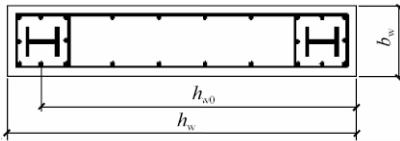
型钢混凝土剪力墙斜截面受剪承载力计算参数示意
